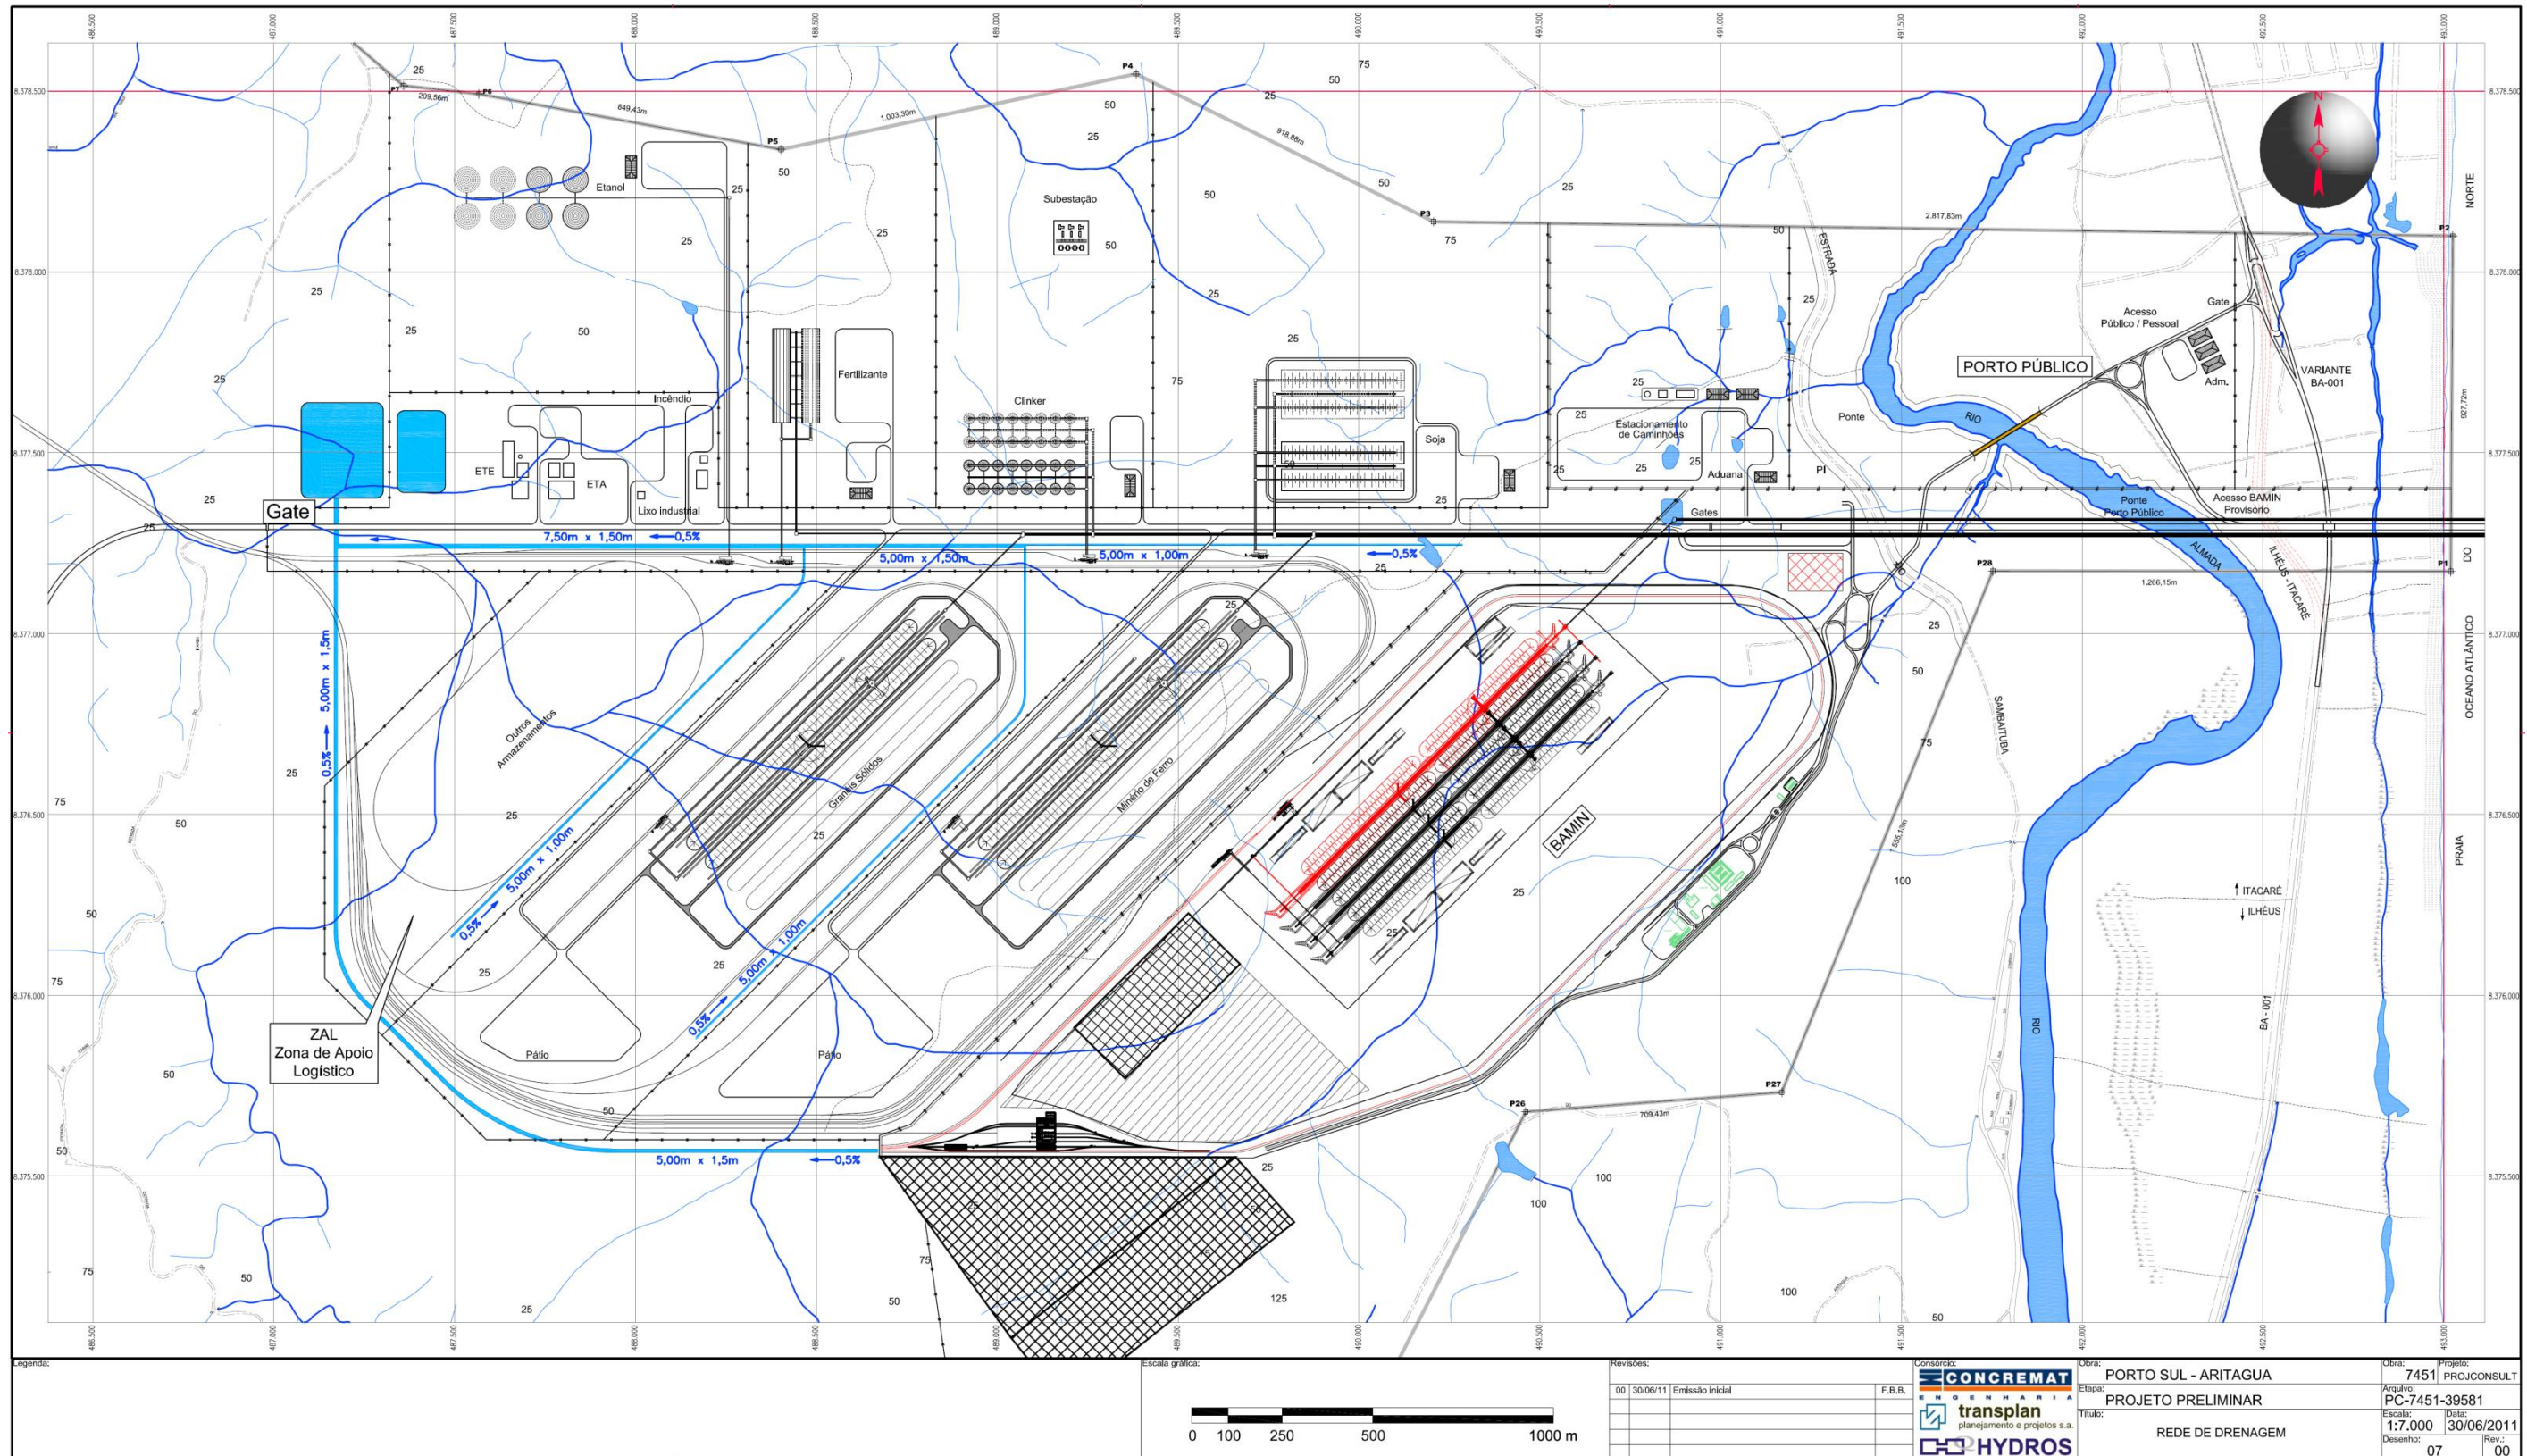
Arranjo Geral do Sistema de Drenagem Pluvial na Área da ZAL – Porto Sul
